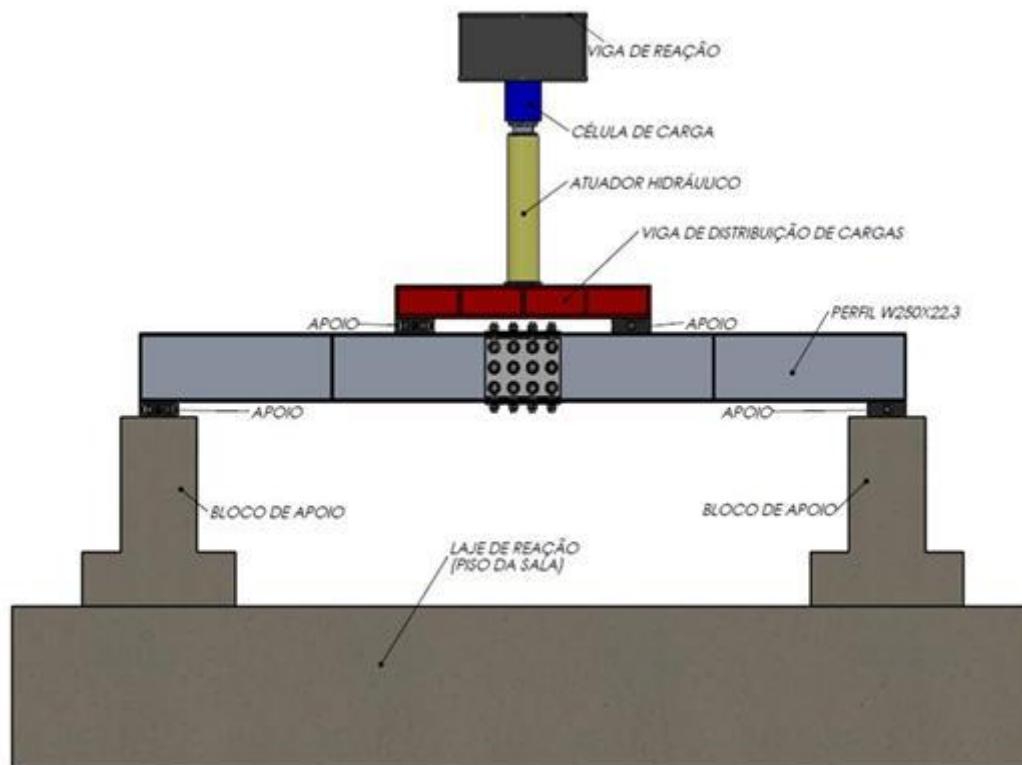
Ilustração do esquema montado para o ensaio de viga.
